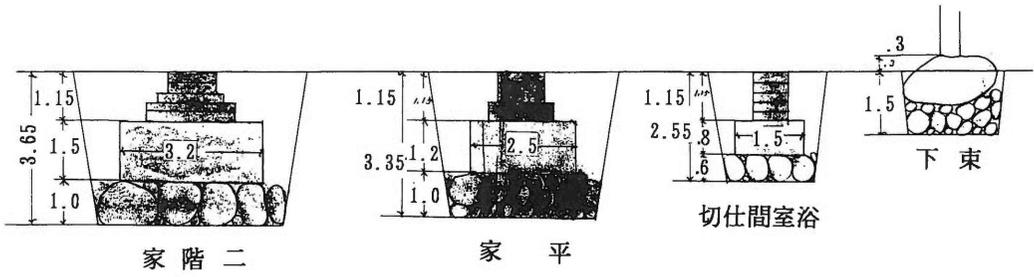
基礎詳細図 (新港俱樂部新築基礎平面圖) (單位 尺)
